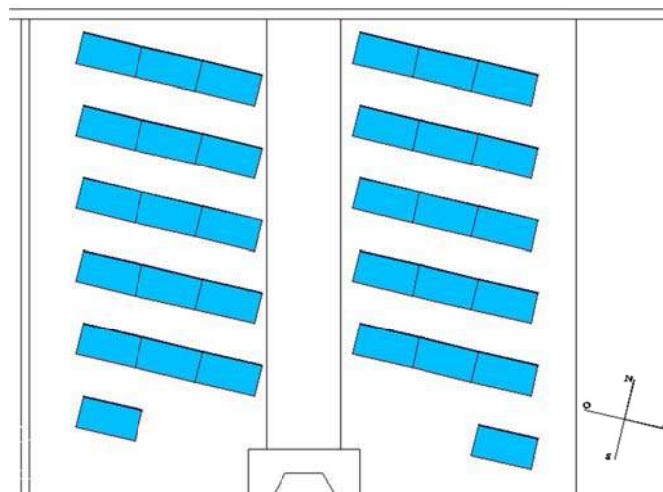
Distribución paneles sobre cubierta Zona 2.
